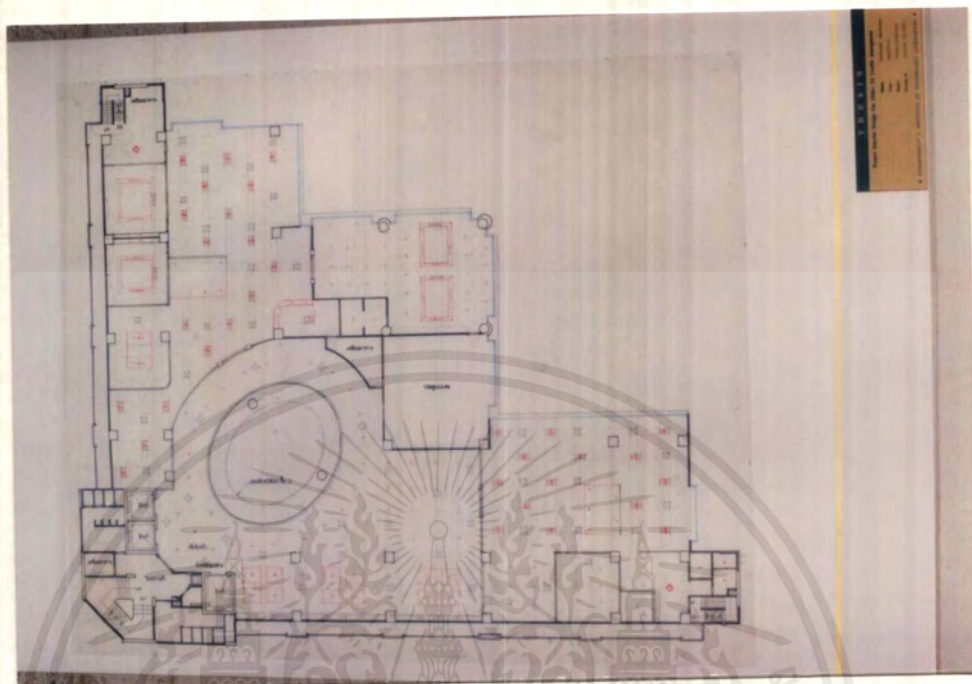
FURNITURE LAY-OUT FOURTH FLOOR PLAN
